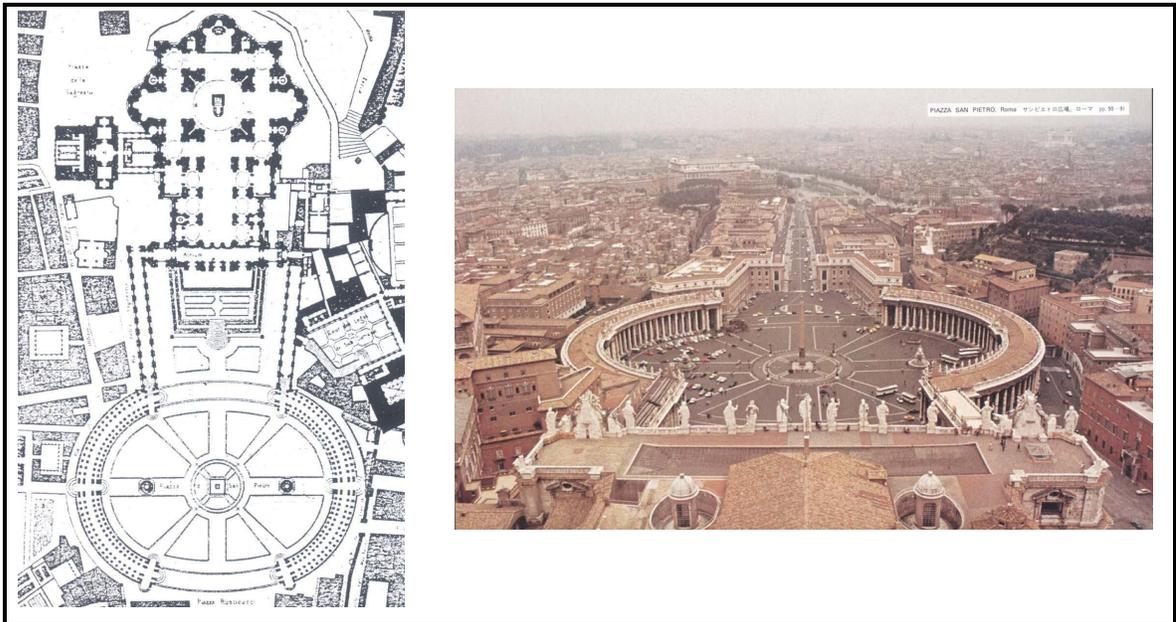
Planta e Vista geral da *Piazza* de São Pedro.
